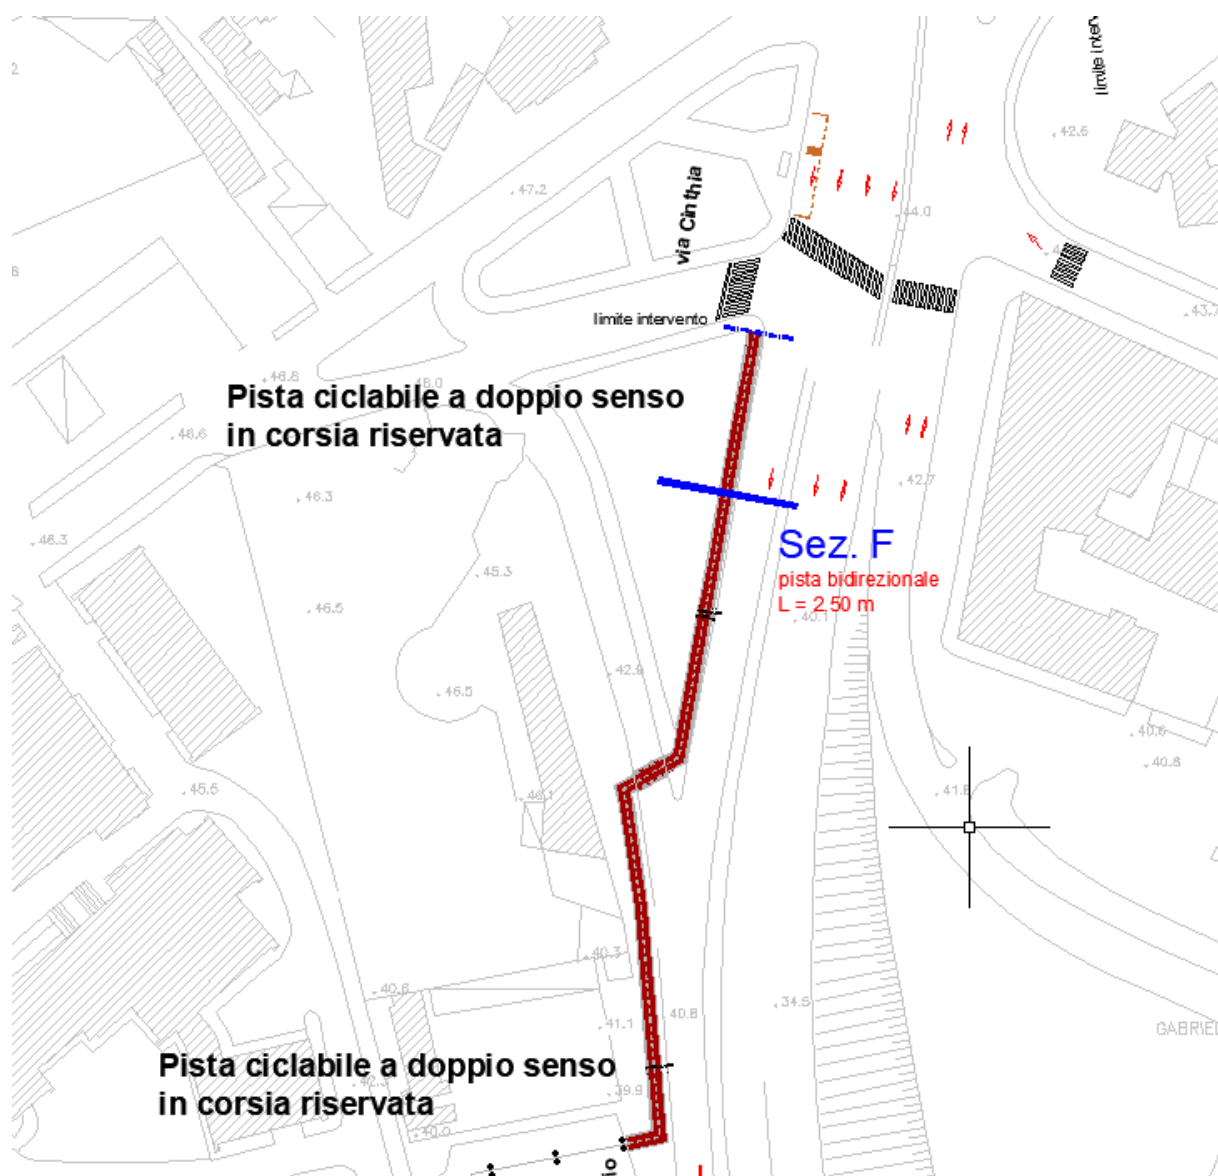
via Claudio – tratto nord, andamento planimetrico della pista ciclabile.
